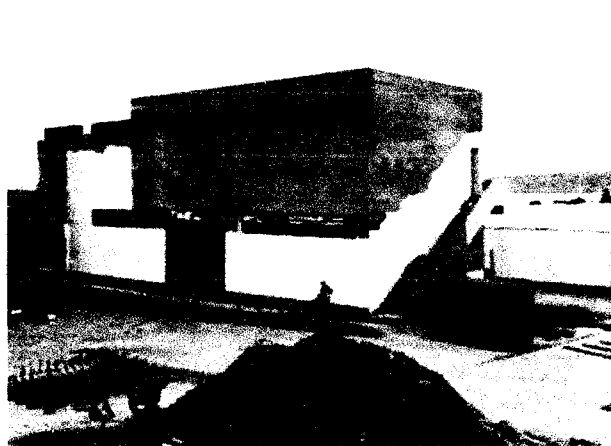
Pintura de muros, columnas y vigas en zona exteriores. Zona de frío
